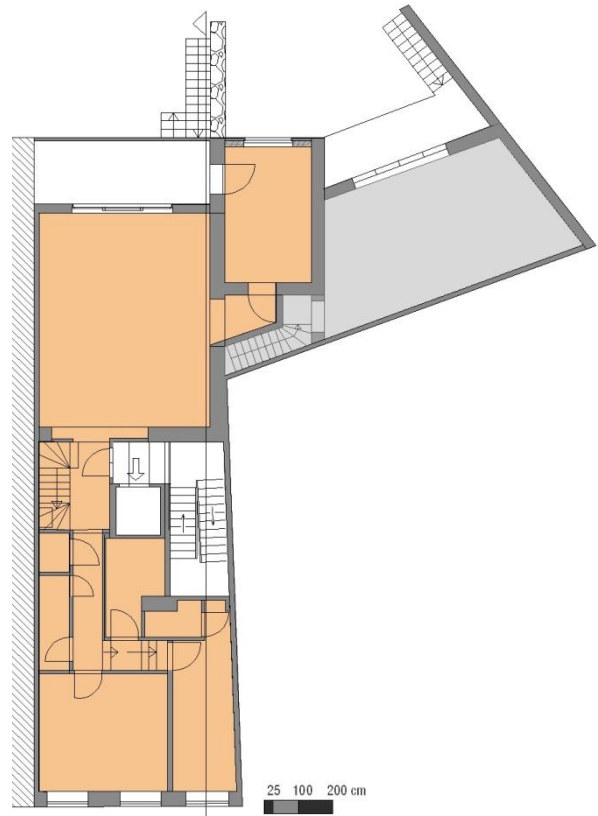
Plan du 1<sup>er</sup> étage (Source : Draps E., 2010)
